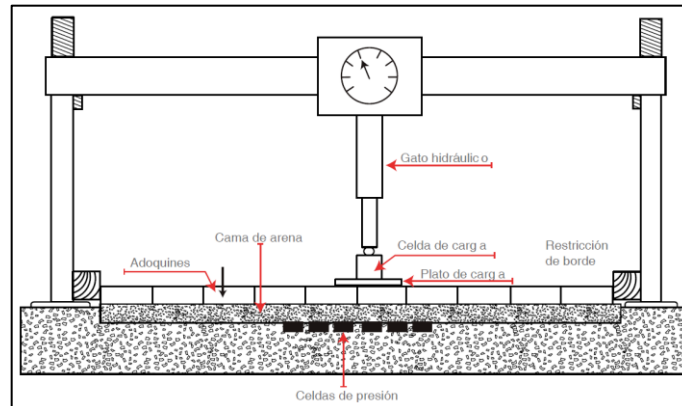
Dispositivo de Knapton para aplicación de carga sobre pavimento adoquinado. [5]
